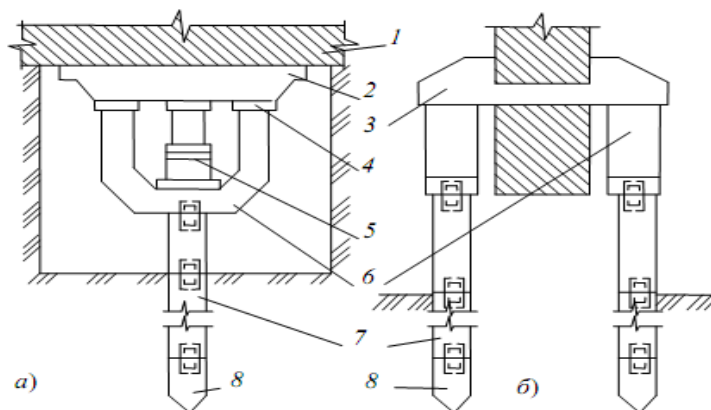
Варіанти підсилення фундаментів залізобетонними здавлюваними палями:
